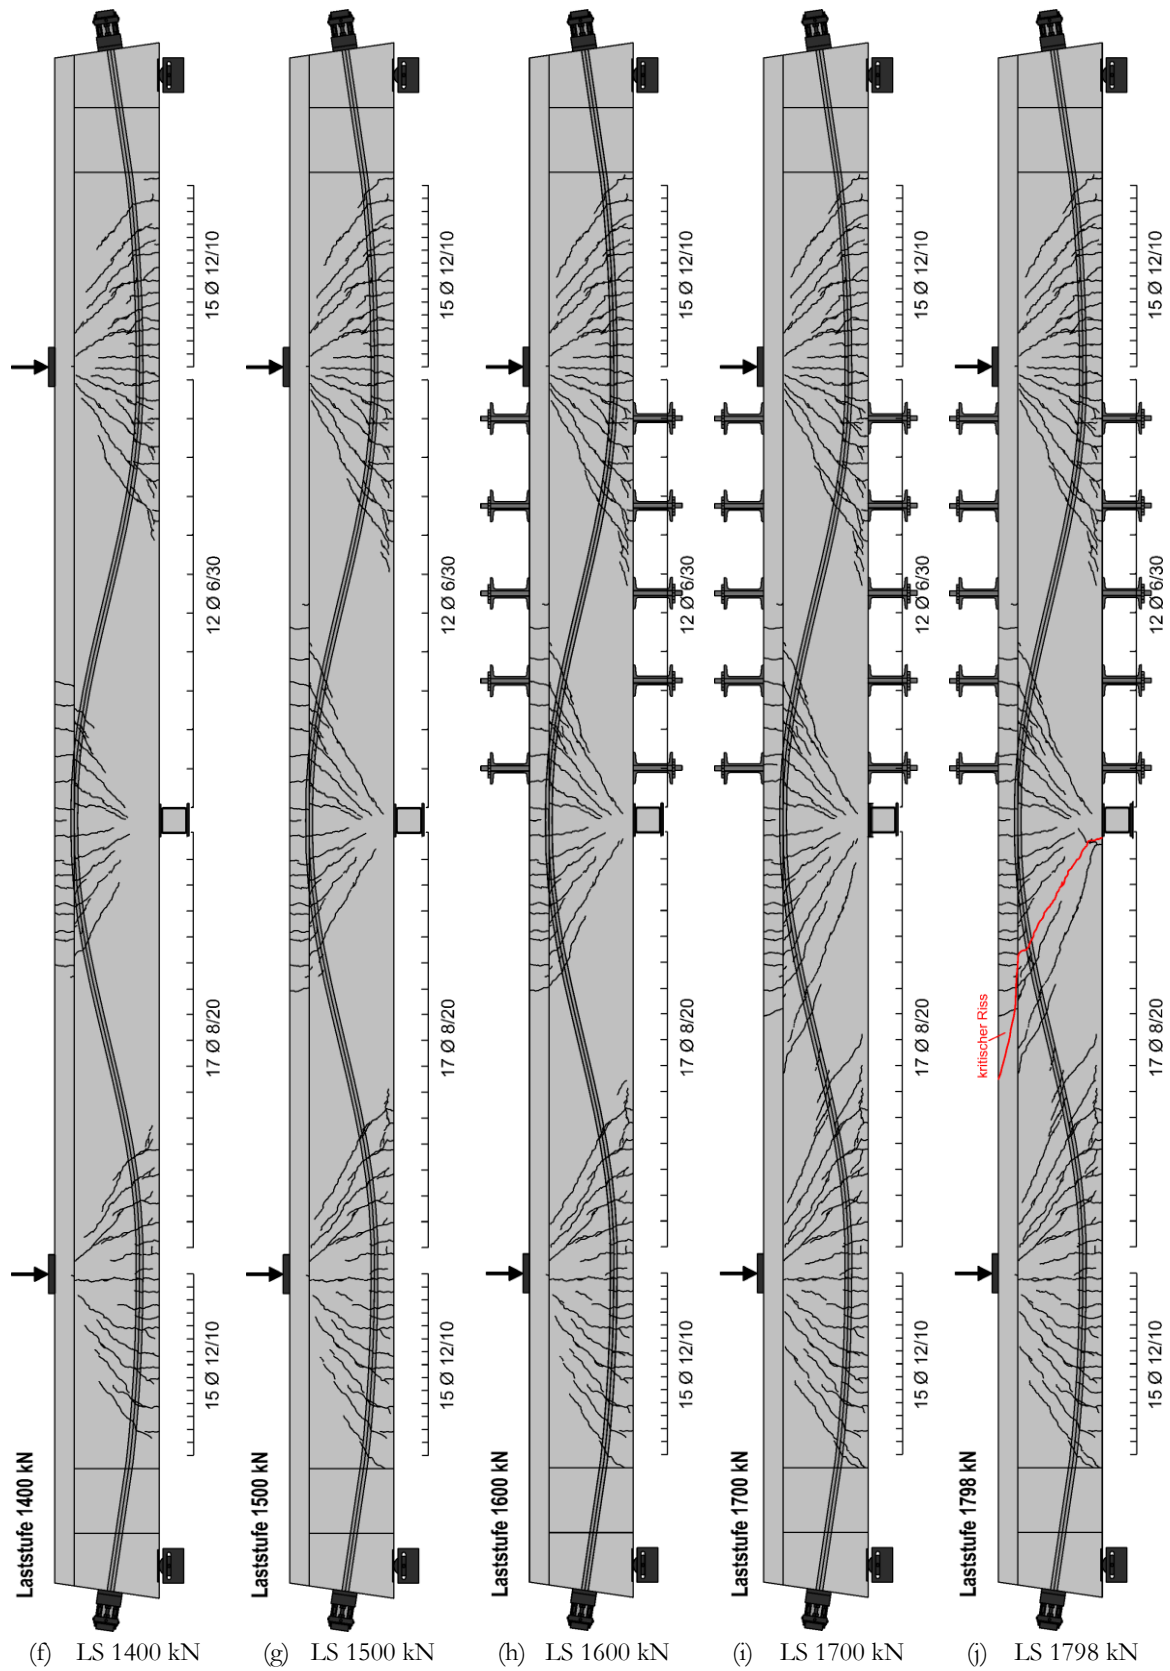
Rissbilder des Versuchsträgers DLT 3 für ausgewählte Laststufen, Teil 2
